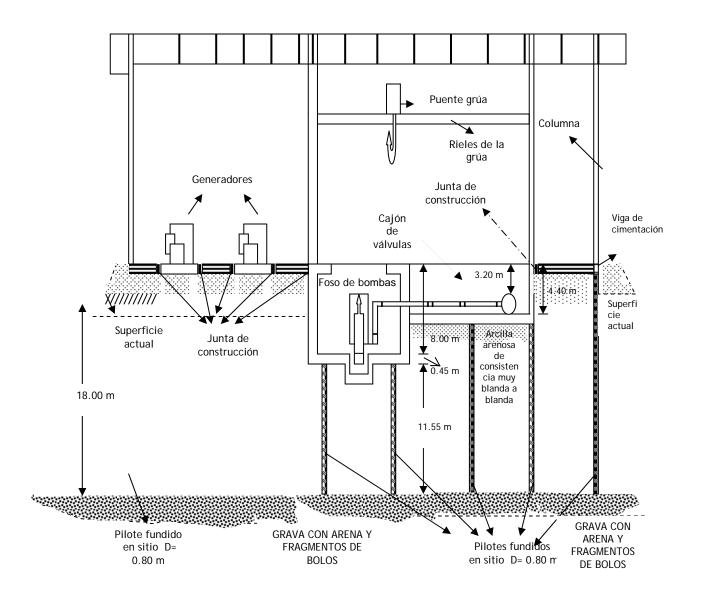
Estación de Bombeo Juan Díaz - Vista lateral; (Corte A-A de la Planta
